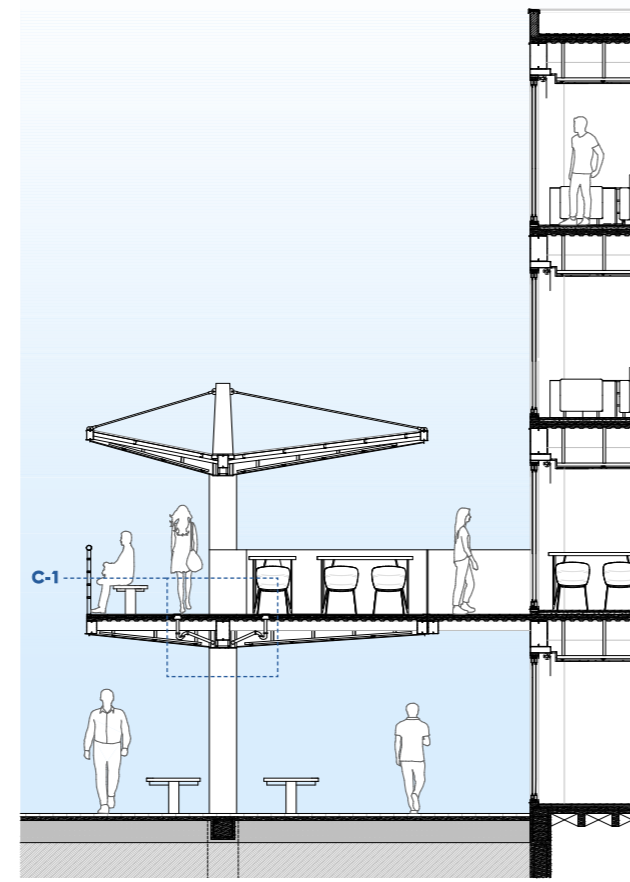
Sección Constructiva S-1-Detalle C-1. Fuente: Elaboración propia (2026)
